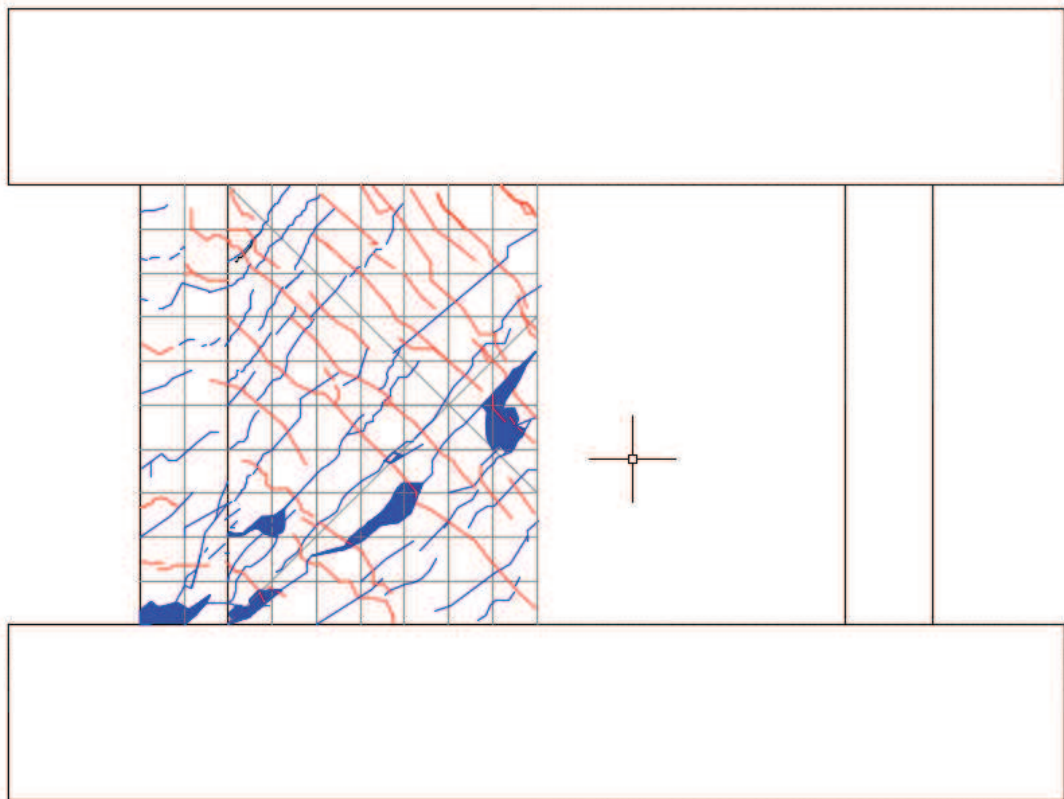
試験体 S-06-D0 最終破壊時ひび割れ図
